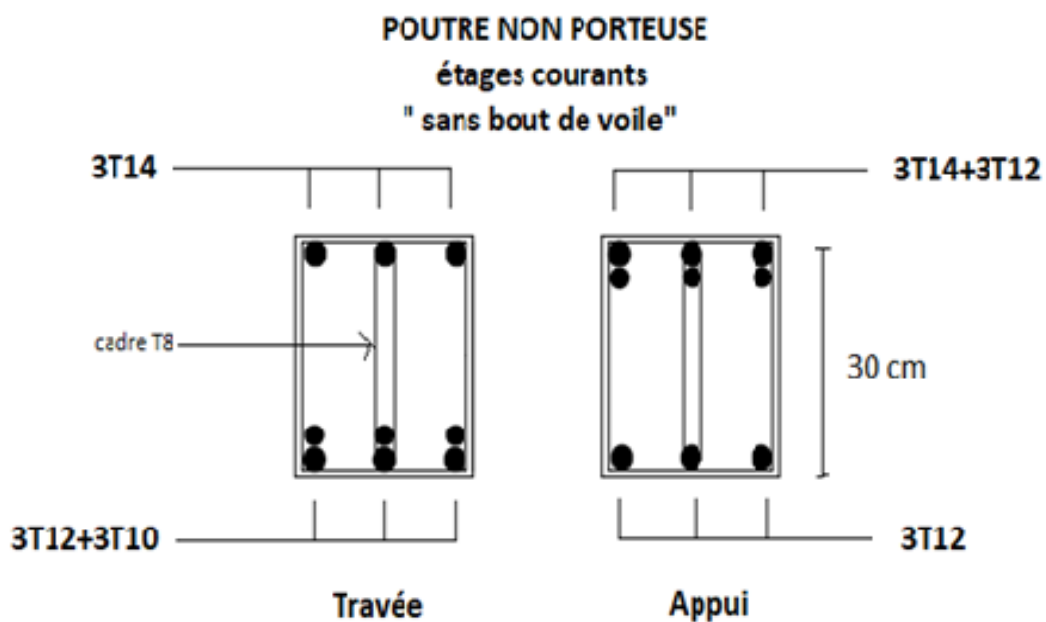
ferrailage des poutres non porteuse Etage Courant sans bout de voile.
